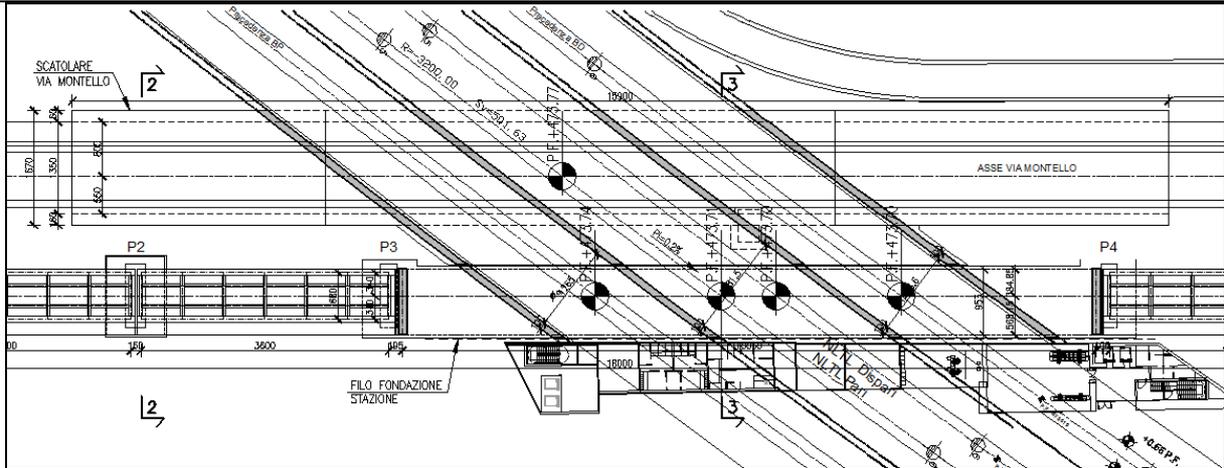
Planimetria viadotto al di sopra della Stazione Internazionale
